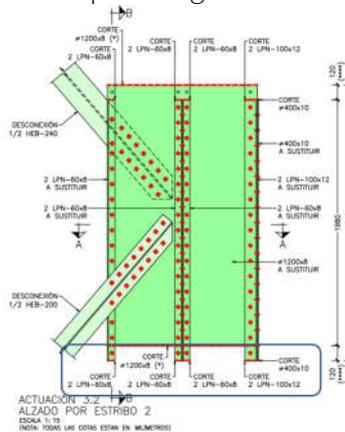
Nudo intermedio mamparo estribo 2. Corte de angulares
